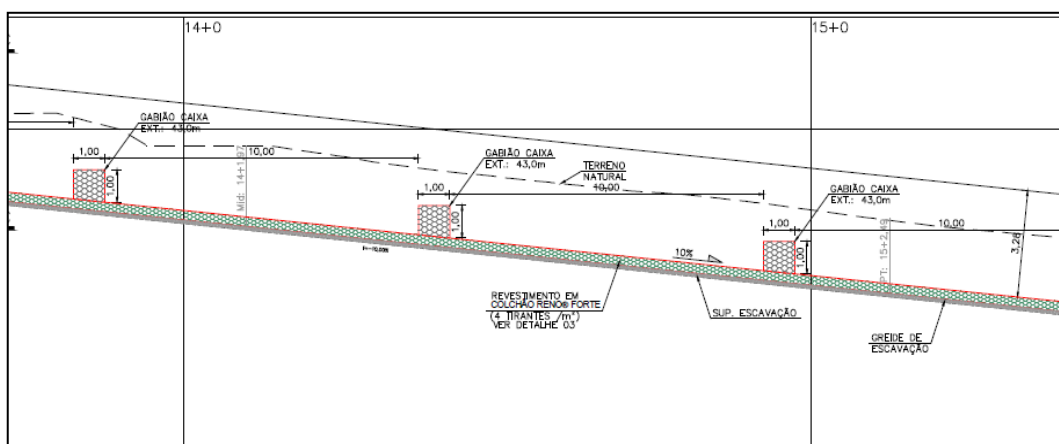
Trecho 2 do perfil longitudinal do extravasor com linhas transversais de gabião caixa
